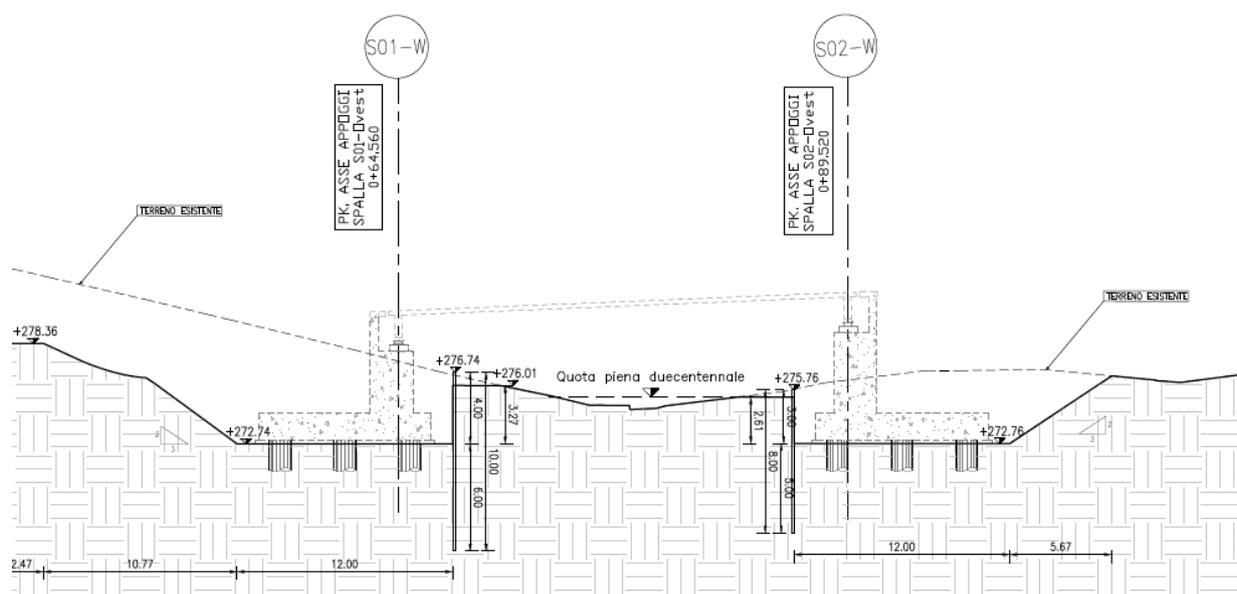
Ultimazione spalle e rilevati stradali di approccio
